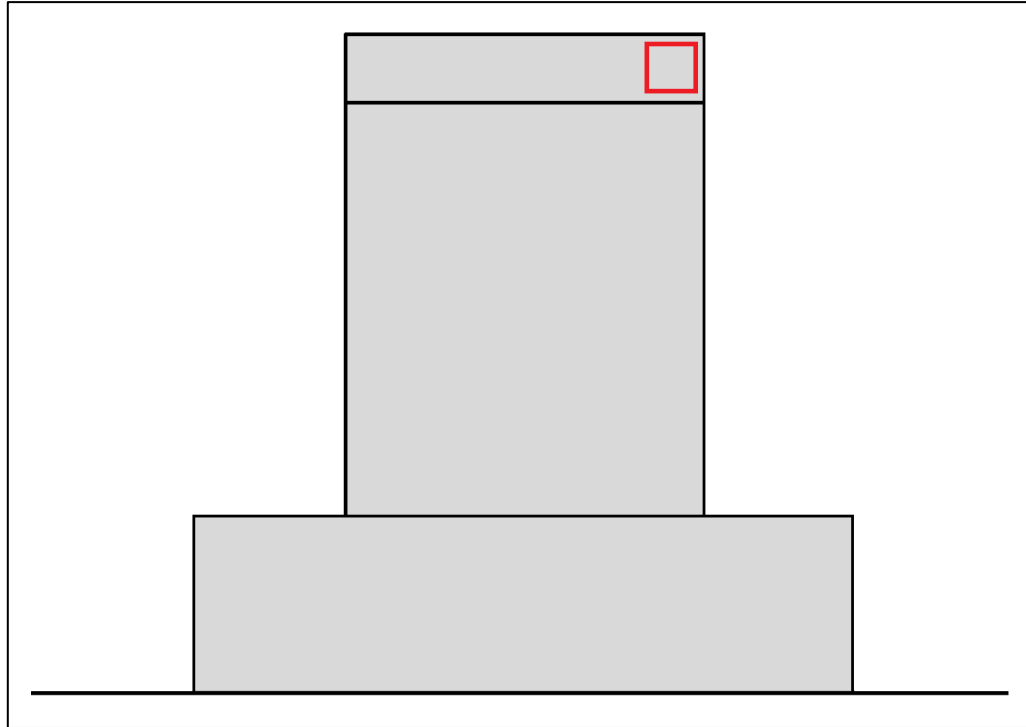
Esquema análisis lado derecho de la viga de coronamiento del muro.
